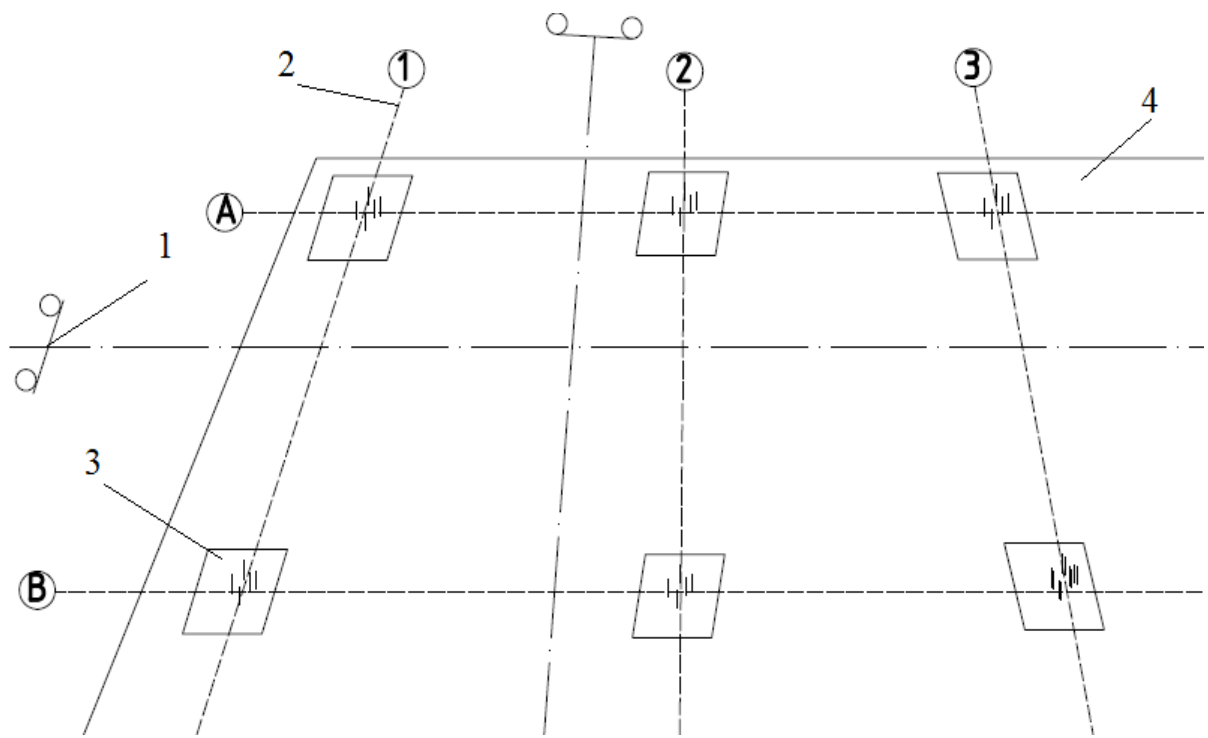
Розмічування фундаменту під колони: 1 – обноска закріплення осей будинку в котловані; 2 – монтажні осі, винесені відносно осей будинку; 3 – положення опалубки під колон; 4 – фундаментна плита
